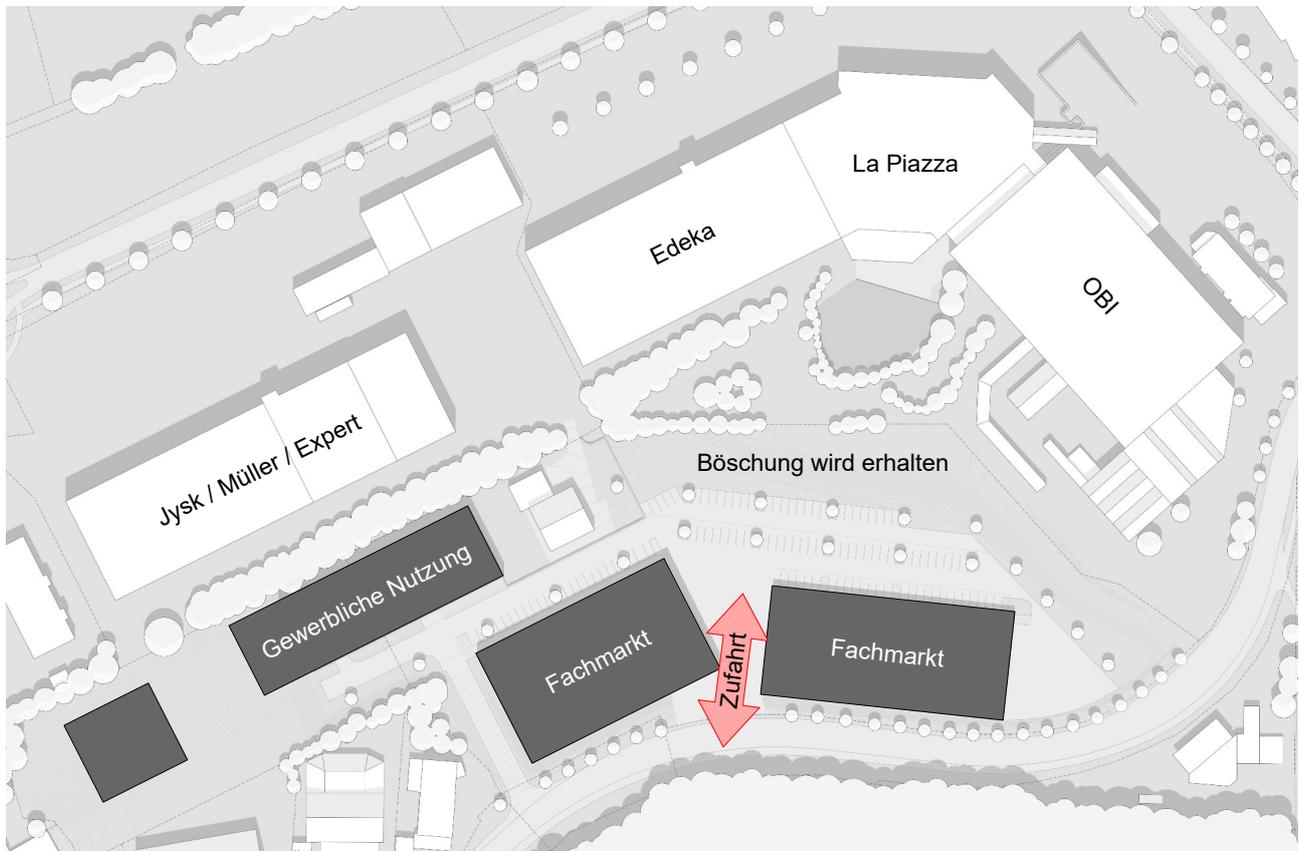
Systemdarstellung Hochbau und Erschließung
